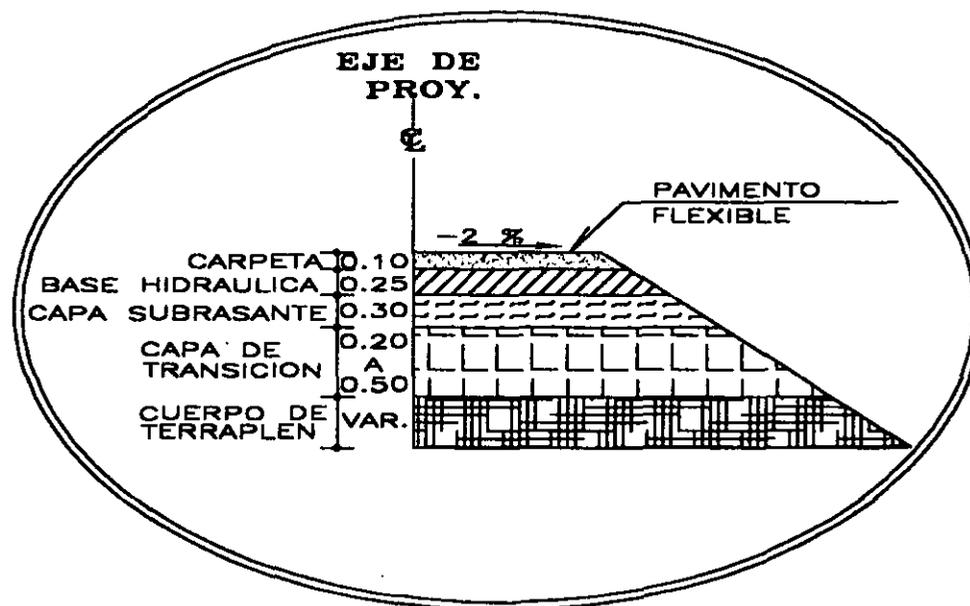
SECCIÓN TIPO ESTRUCTURAL EN CORTE.
